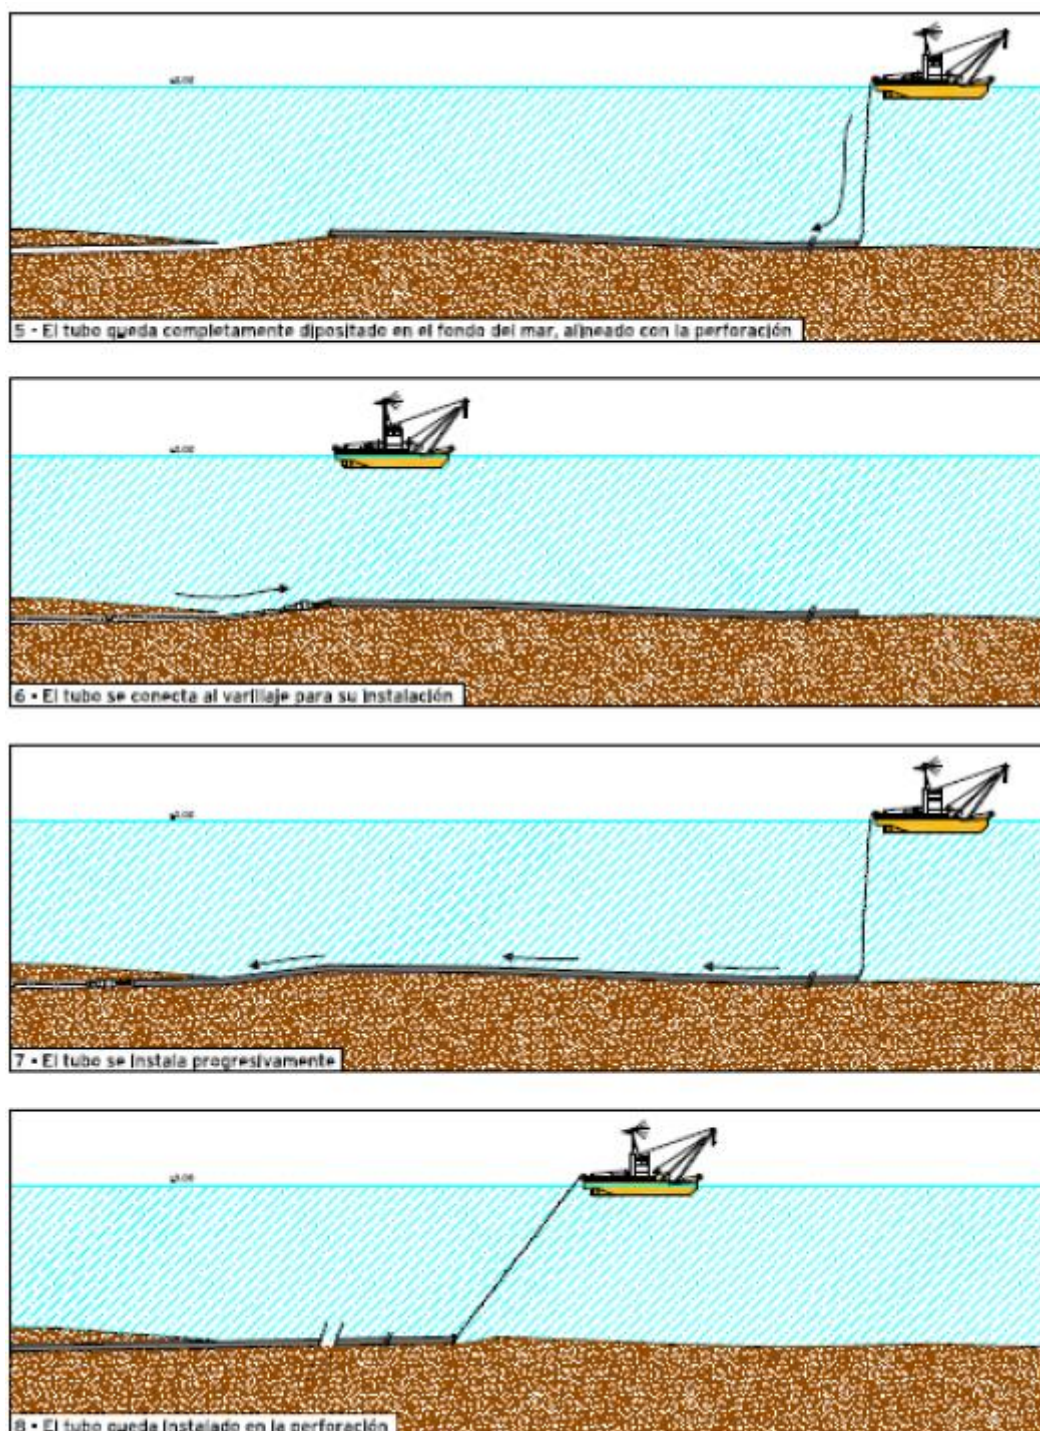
Proceso constructivo de colocación de la tubería en el interior de la PHD.
